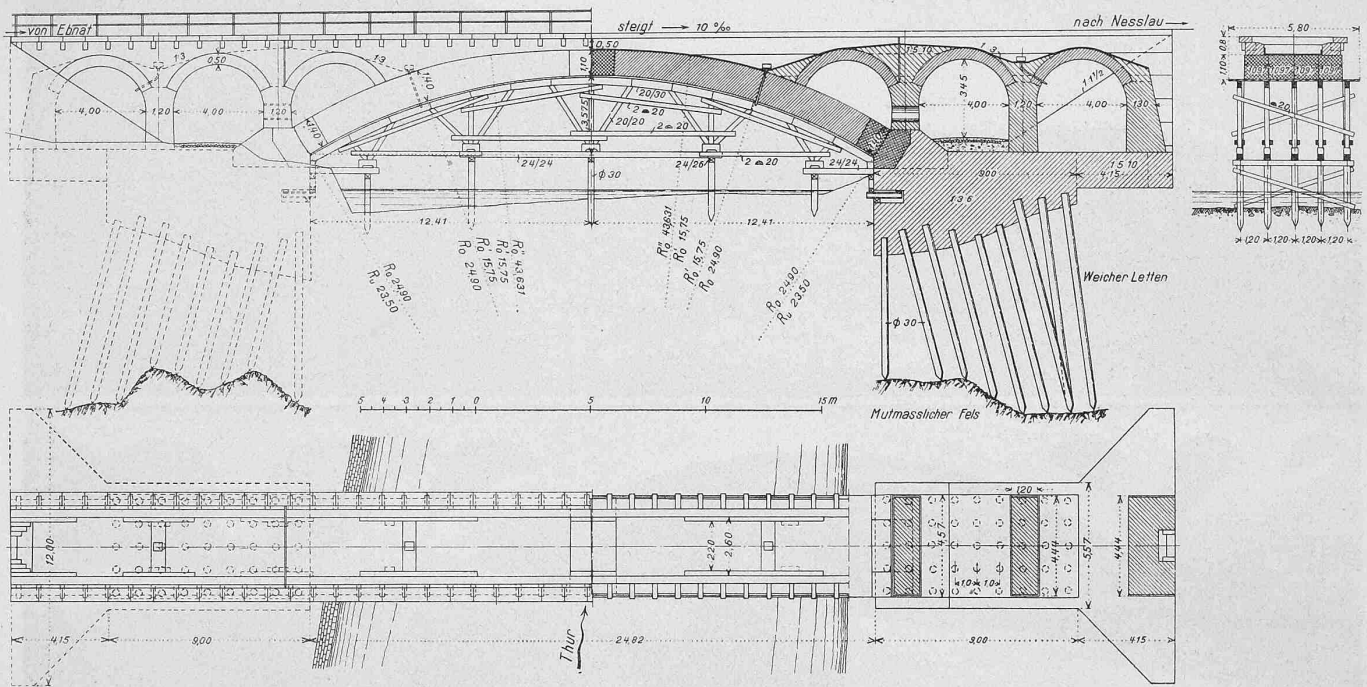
Steinerne Thurbrücke bei Km. 6,650. — Ansicht, Grundriss und Schnitt. — Masstab 1 : 300.
